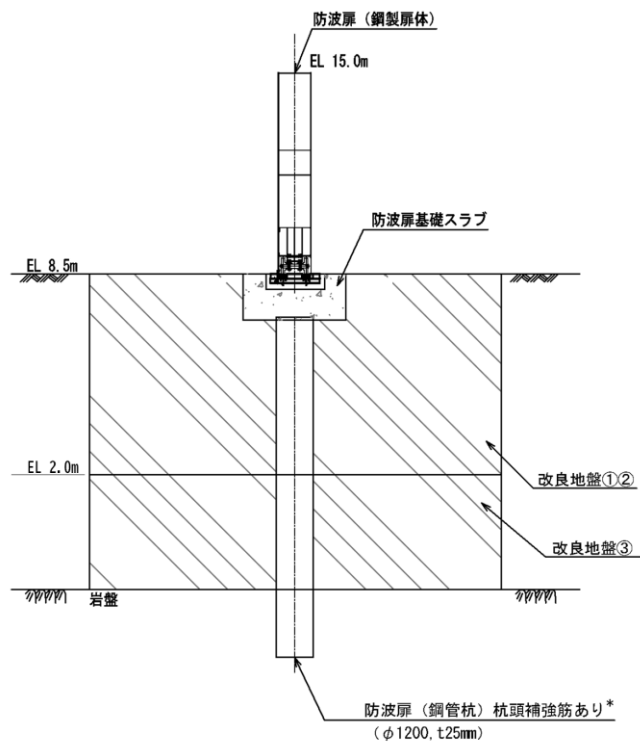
(2) 防波扉の構造図 (基礎, 断面図)
